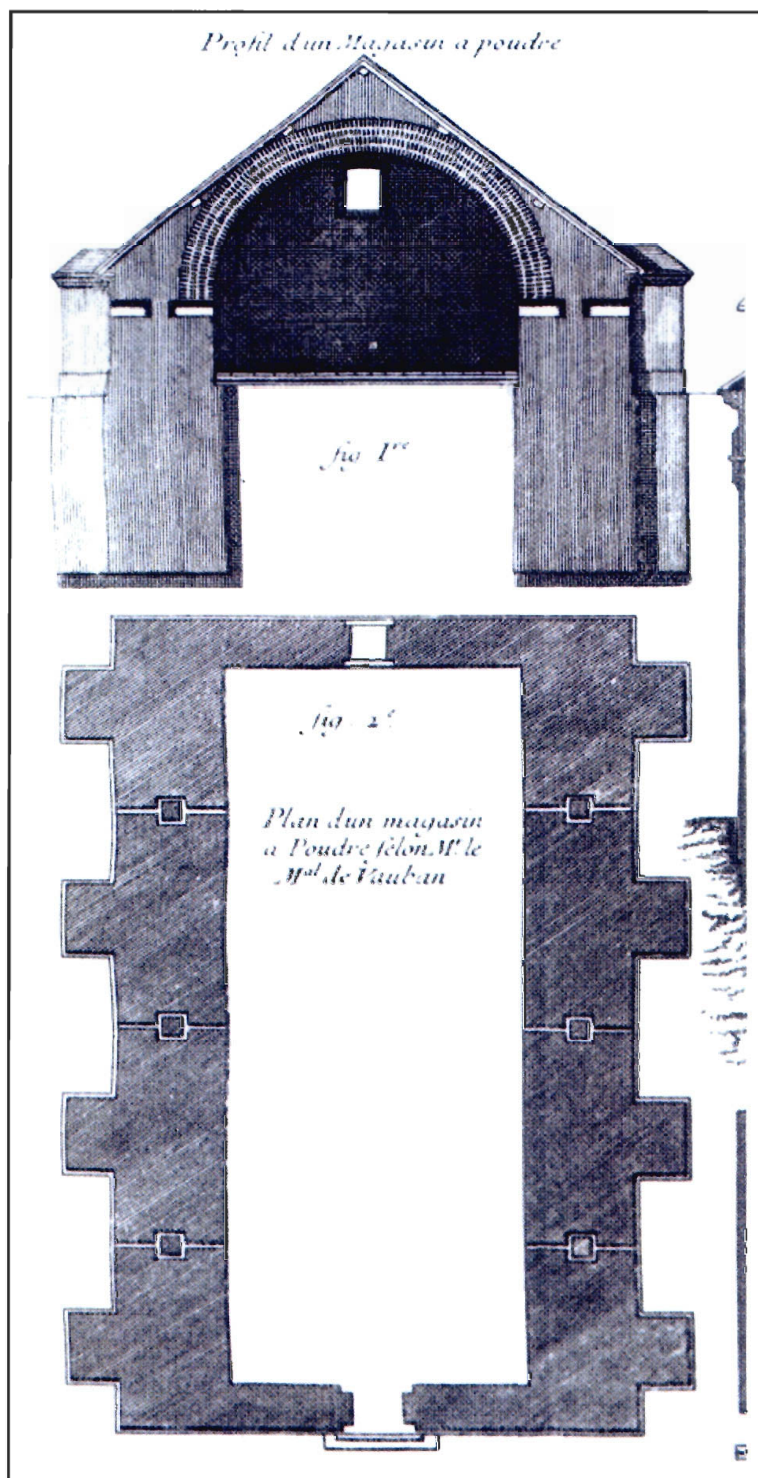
« Plan type d'une poudrière telle que construite par Vauban » (reproduit dans CHARBONNEAU *et al.* 1982 : 219)
